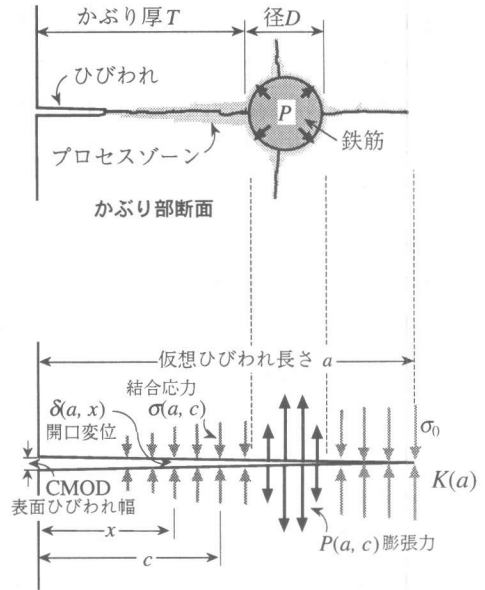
鉄筋膨張によるひびわれ進展のモデル化
